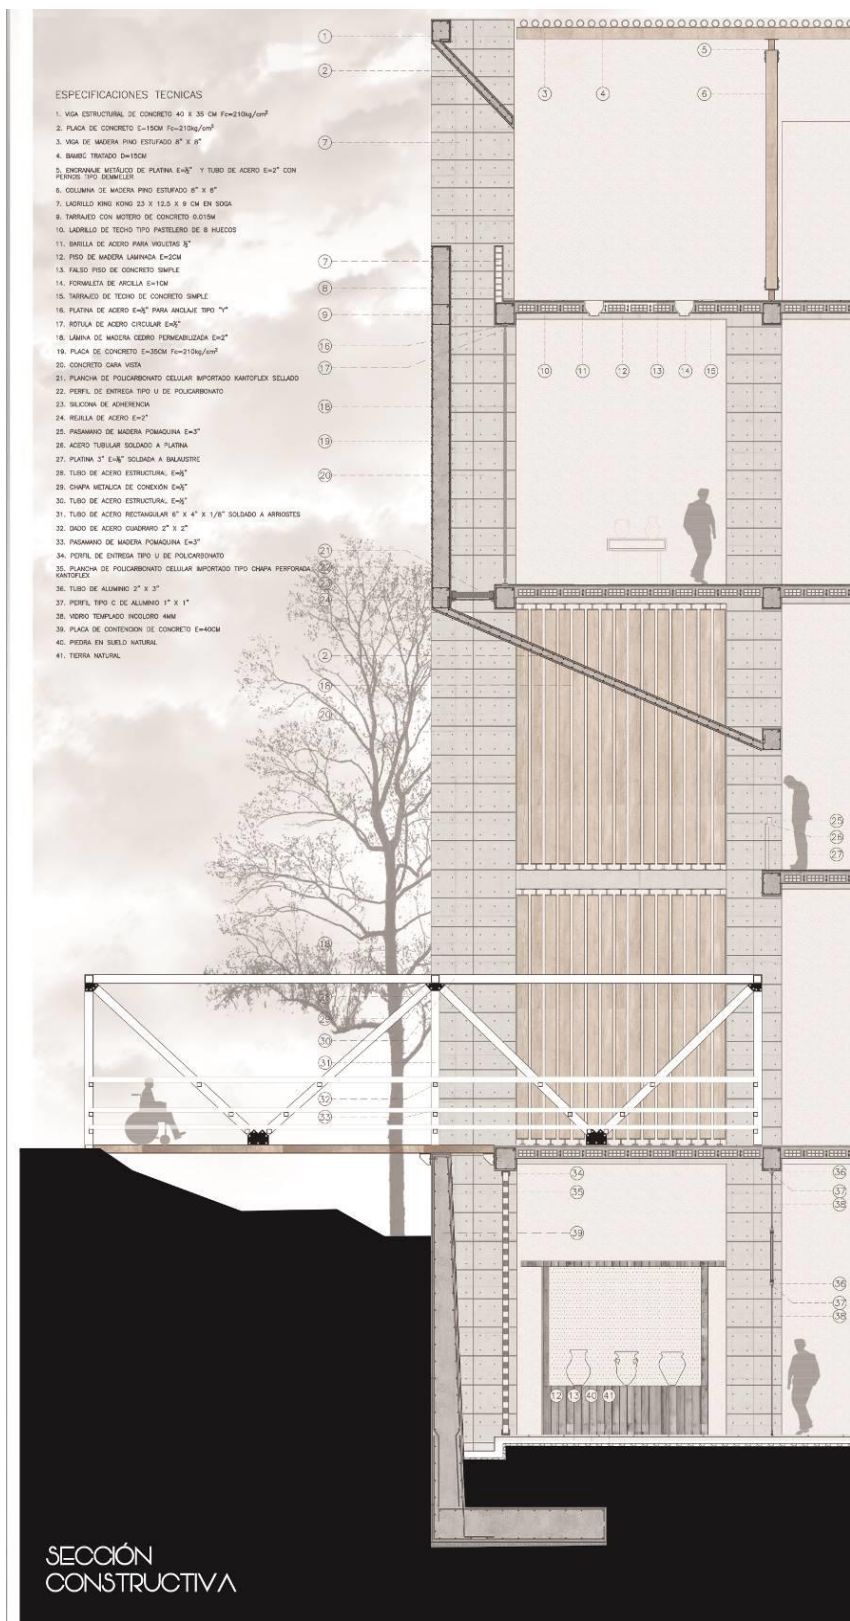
Corte estructural, 3D. Fuente: Elaboración propia.
